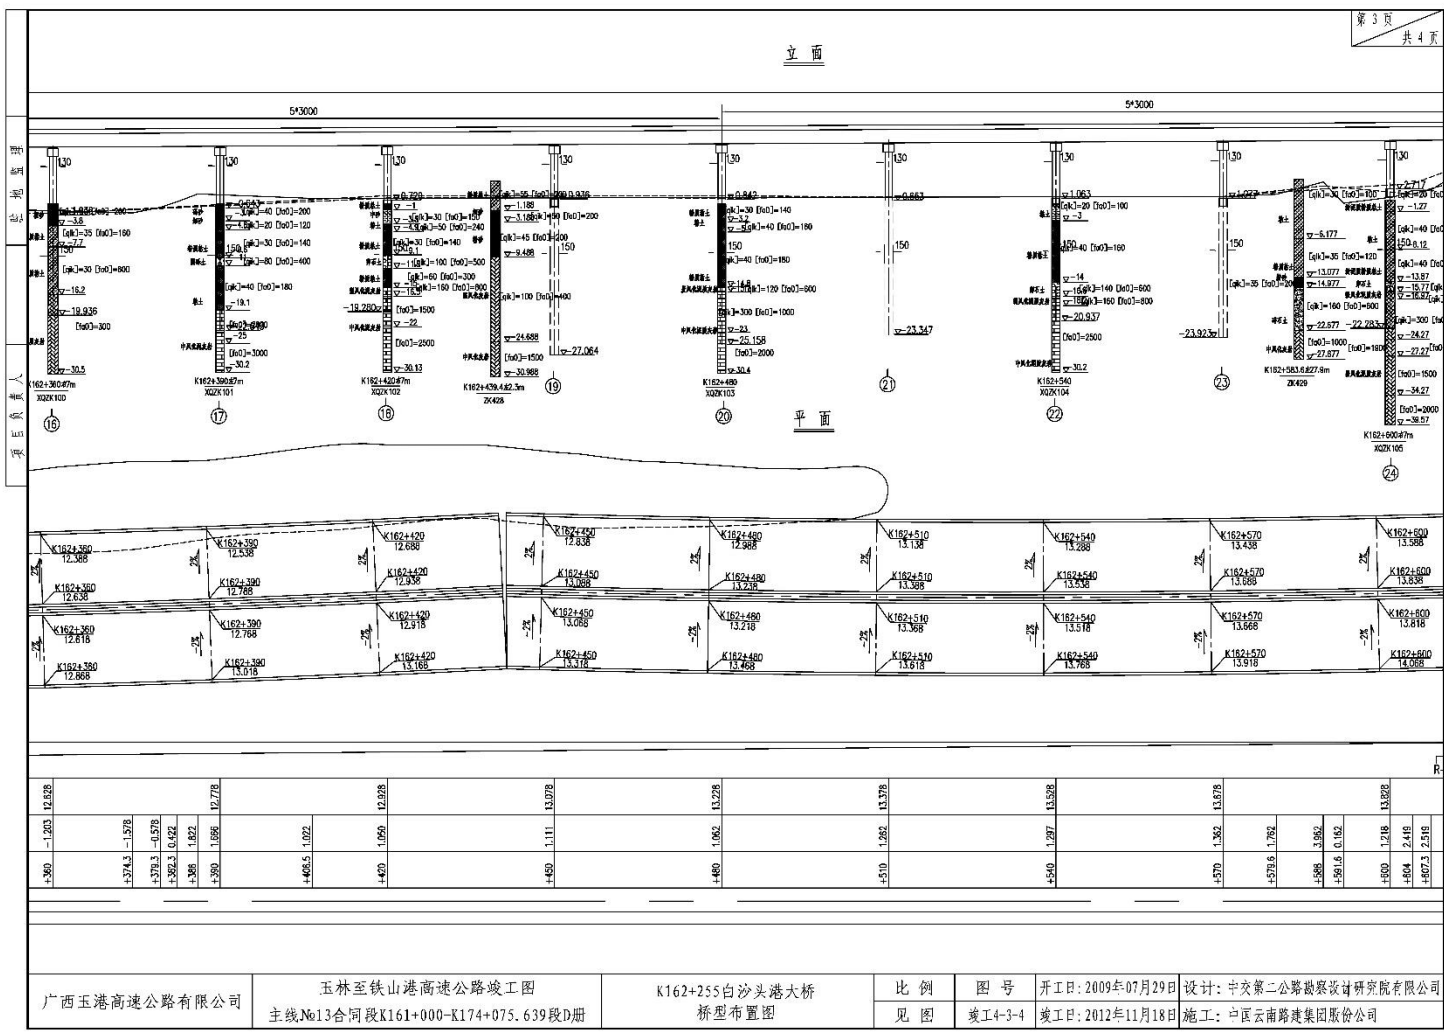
(3) 白沙头港大桥总平面布置图-分幅 3
